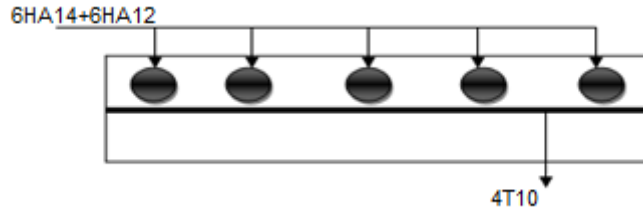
Schéma de ferrailage de la dalle pleine sur 3 appuis
